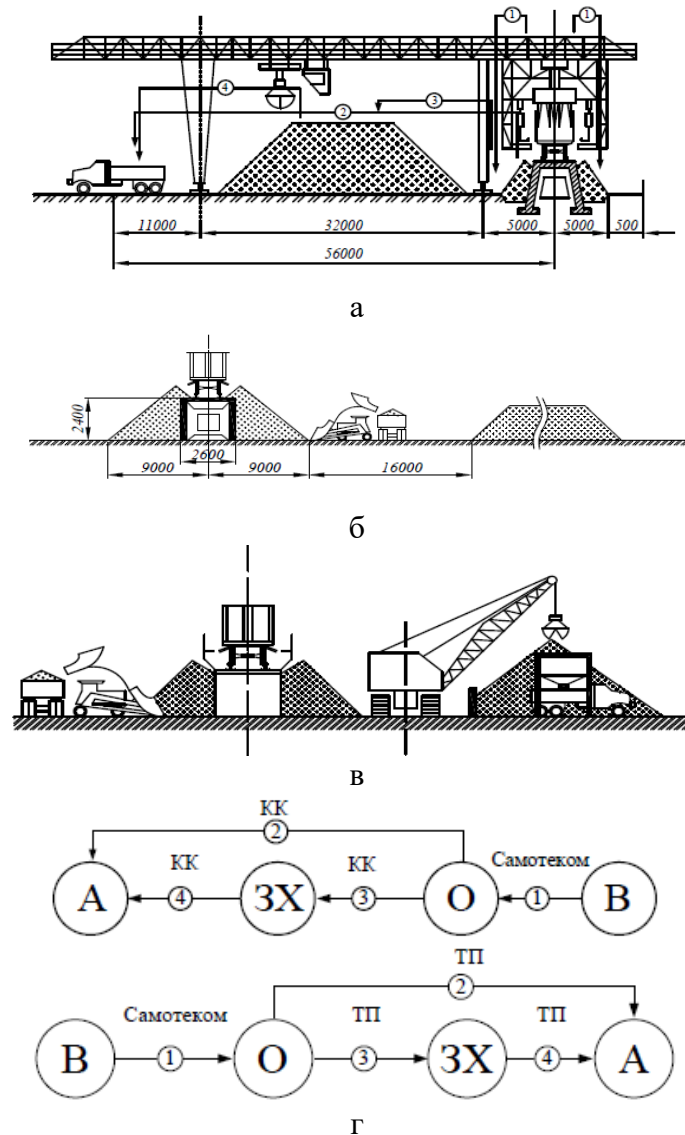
Схемы переработки сыпучих грузов при выгрузке самотеком в отвалы вдоль повышенного пути:
